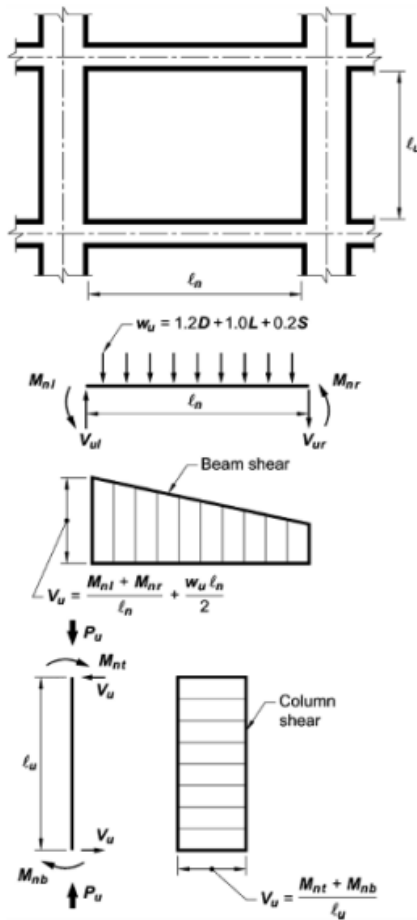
Cortante de diseño para vigas y columnas intermedias
